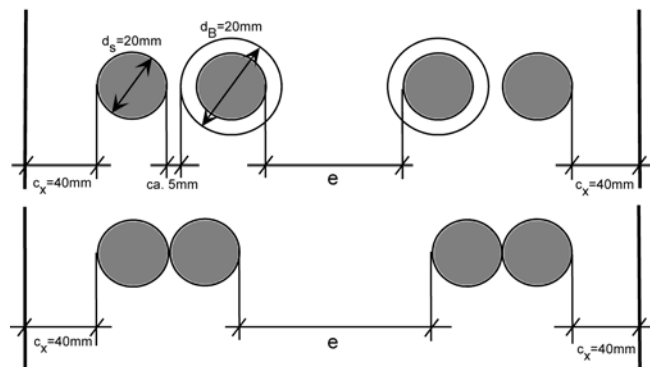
Position der eingemörtelten und einbetonierten Bewehrungsstäbe
